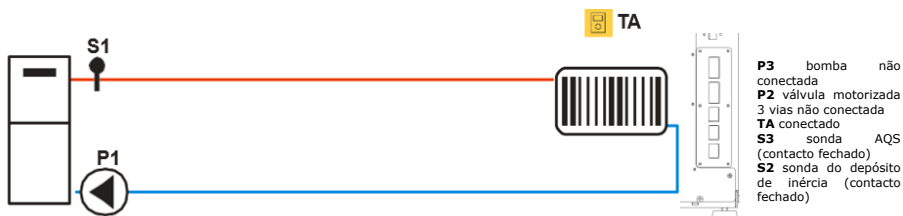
Ligação simples apenas a radiadores de aquecimento central
